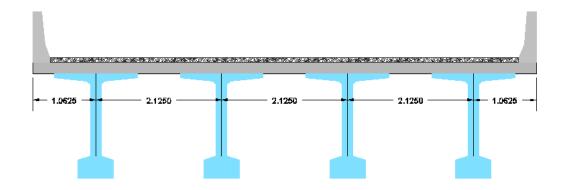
SECCION TRANSVERSAL DE LA SUPERESTRUCTURA PUENTE
